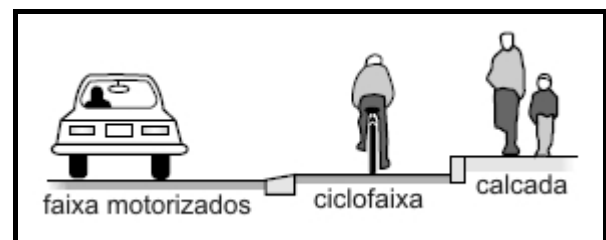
Esquemático de seção de ciclofaixa elevada.
